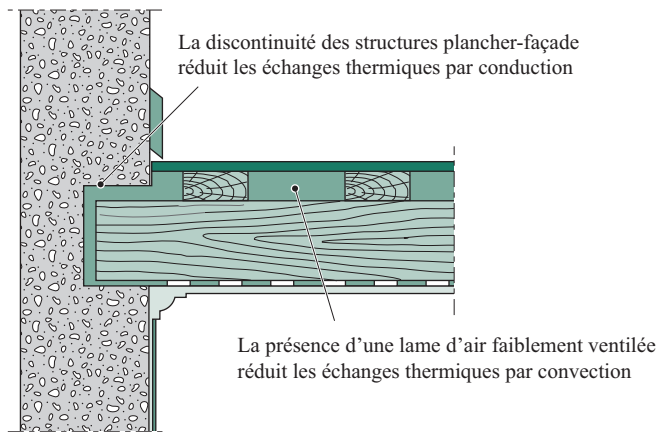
Exemple d'un plancher complet : poutres encastées, enfermées dans un caisson en plâtre.
